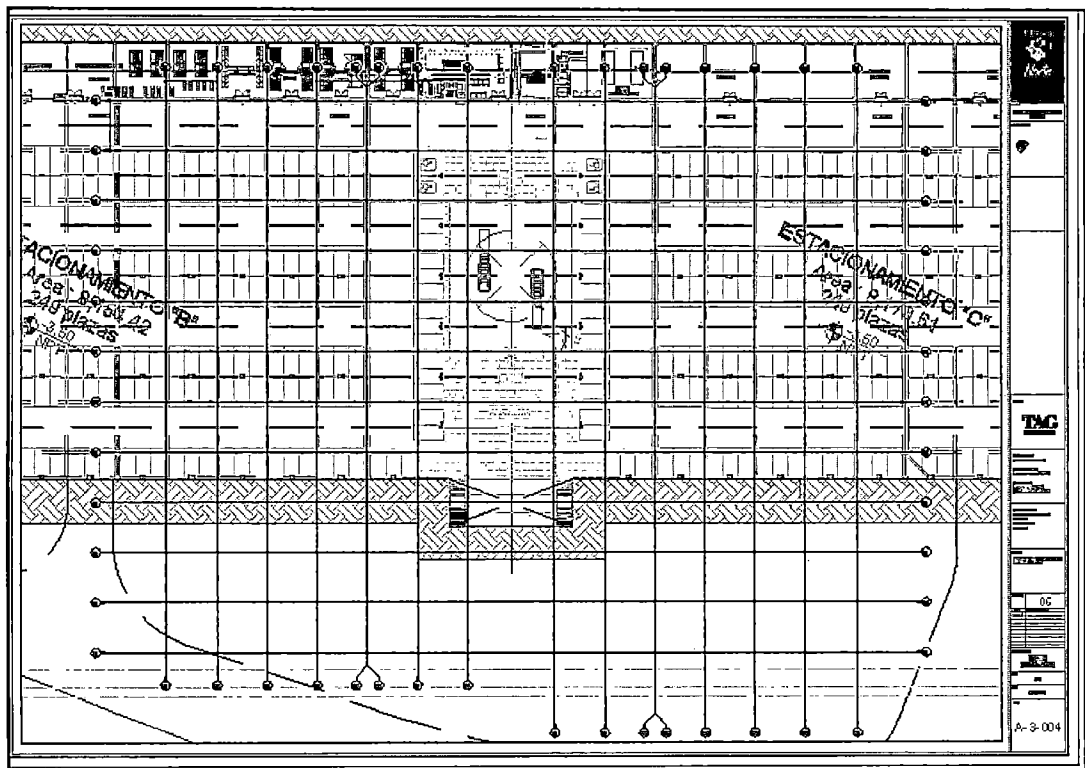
PLANTA SÓTANO DEL SECTOR 03.
